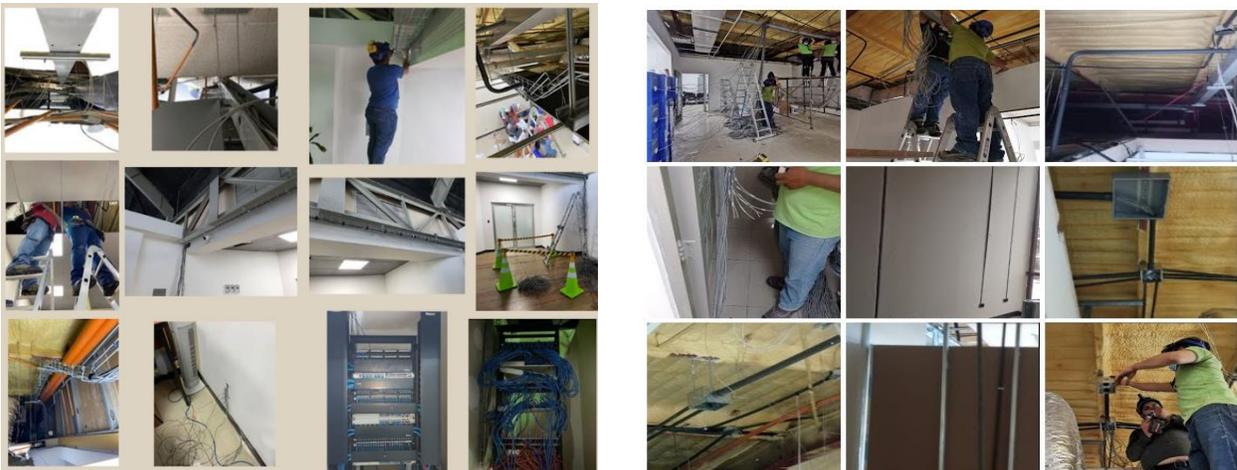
Proyecto Archivo General y Unidad de Talleres - Planta La Brigada
